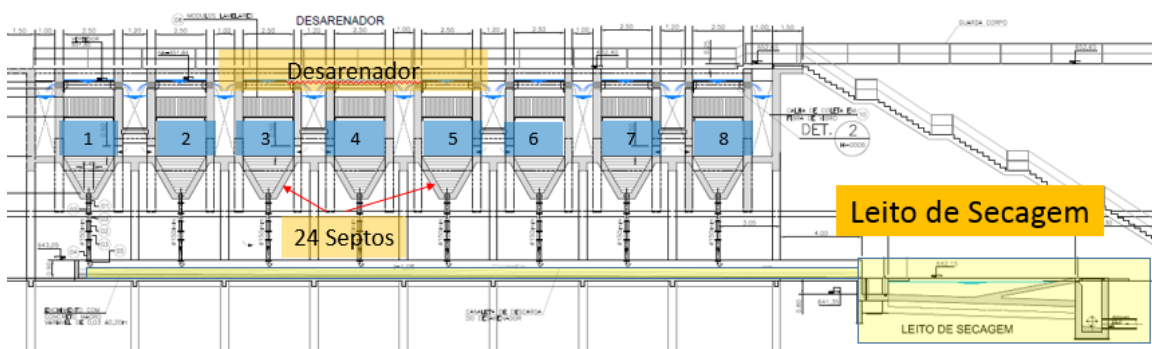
Vista em corte do conjunto Desarenador / Leito de secagem.
